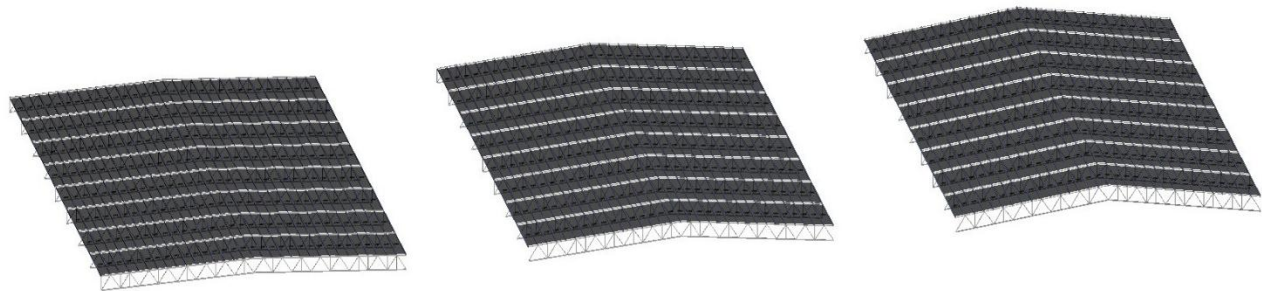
Armaduras Warren con pendientes del 6-11-22% para la muestra 6 (50X80 m).
